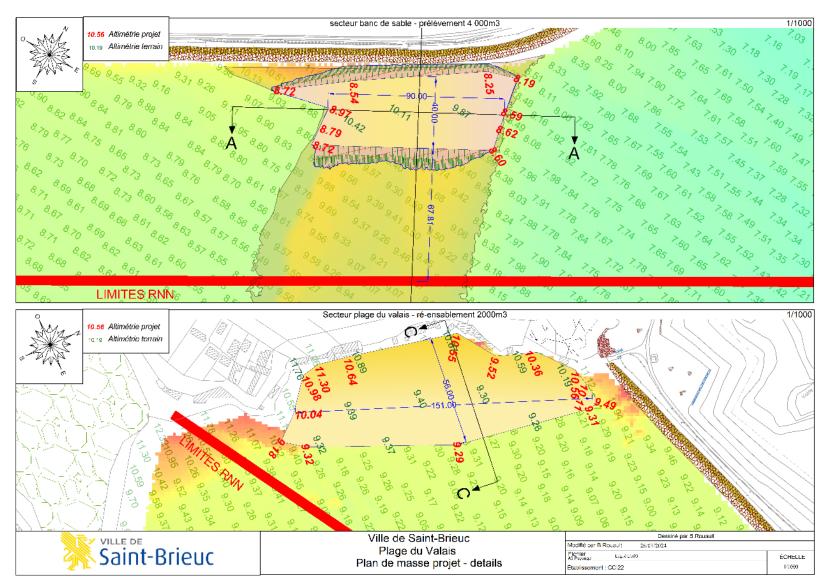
Plan masse détaillé sur les zones projet (CCI22)
